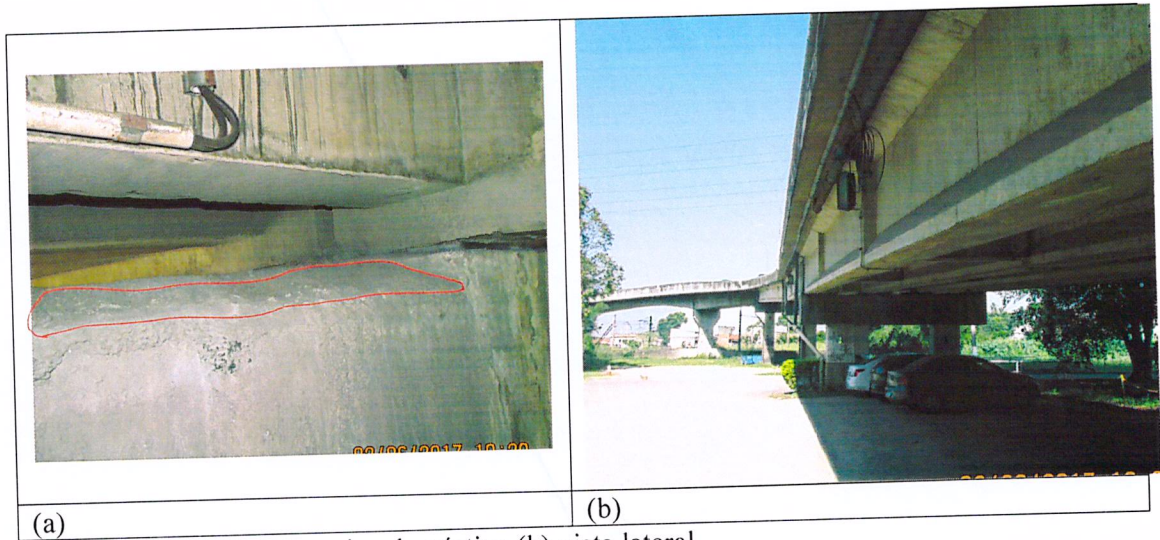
(a) resíduos sobre viga do pórtico (b) vista lateral
